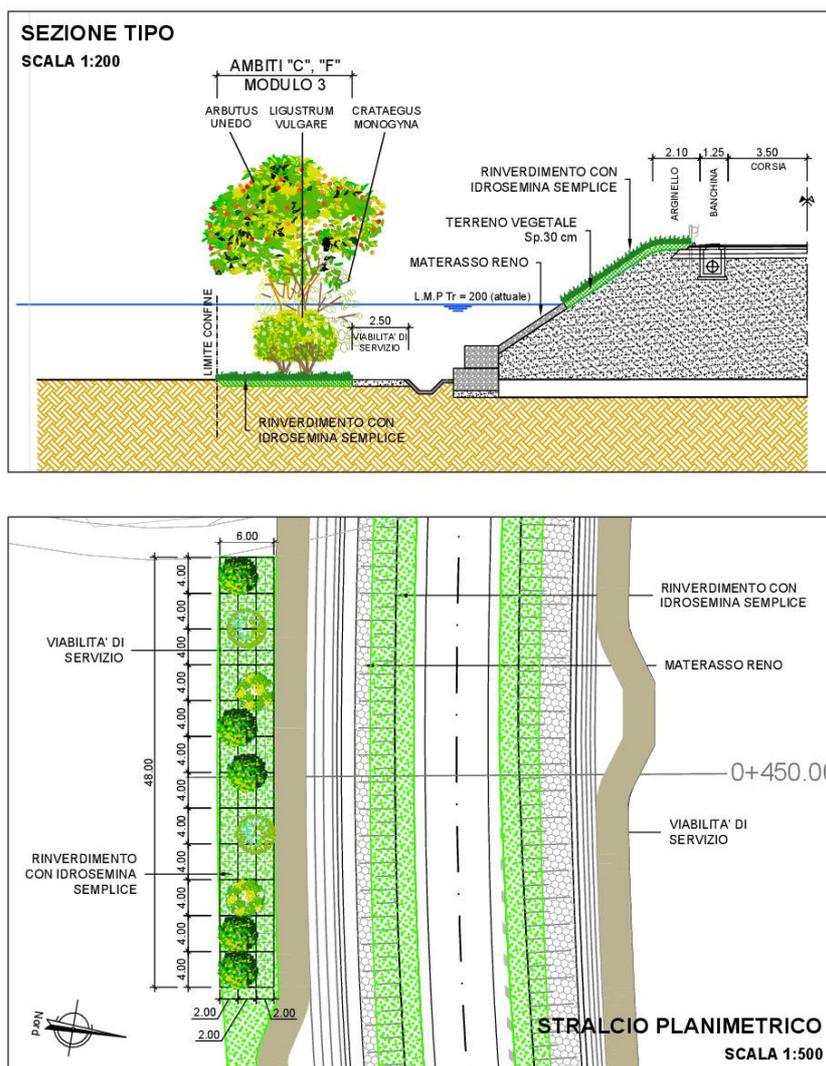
Stralcio planimetrico e sezione - Ambito C, Modulo 3 – Lato Monterotondo Scalo
